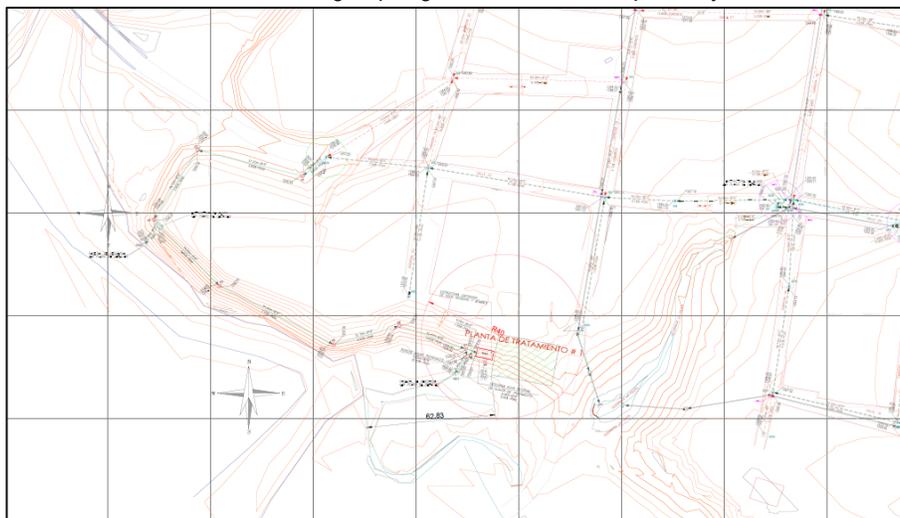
Plano Planta General – Conexión Alcantarillado A.R. a Planta de tratamiento #1
